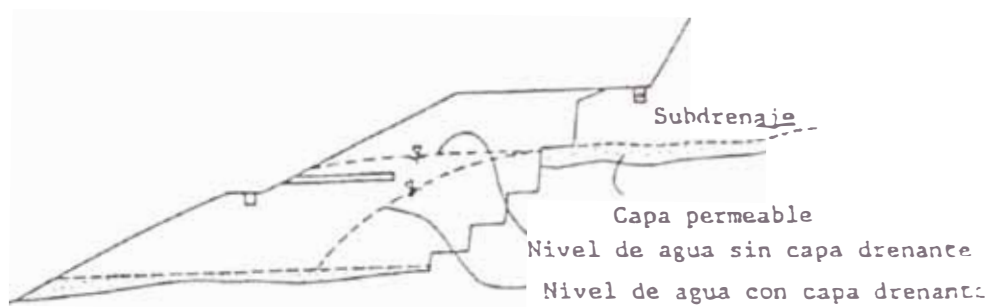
OBRAS DE DRENAJE Y CAPA DRENANTE PARA EL RELLENO EN TERRENO INCLINADO.
